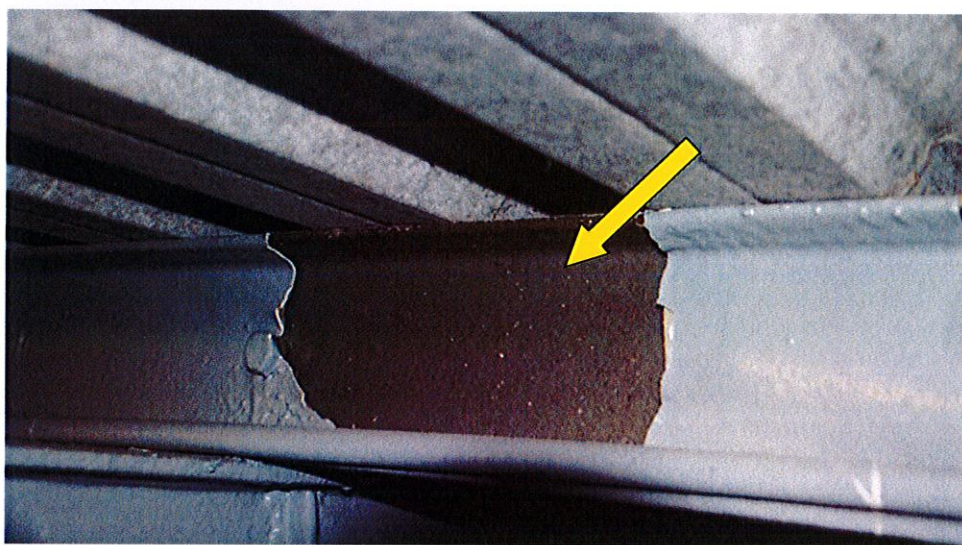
Plyta betonowa nad Salą Eryka Pomorskiego.
